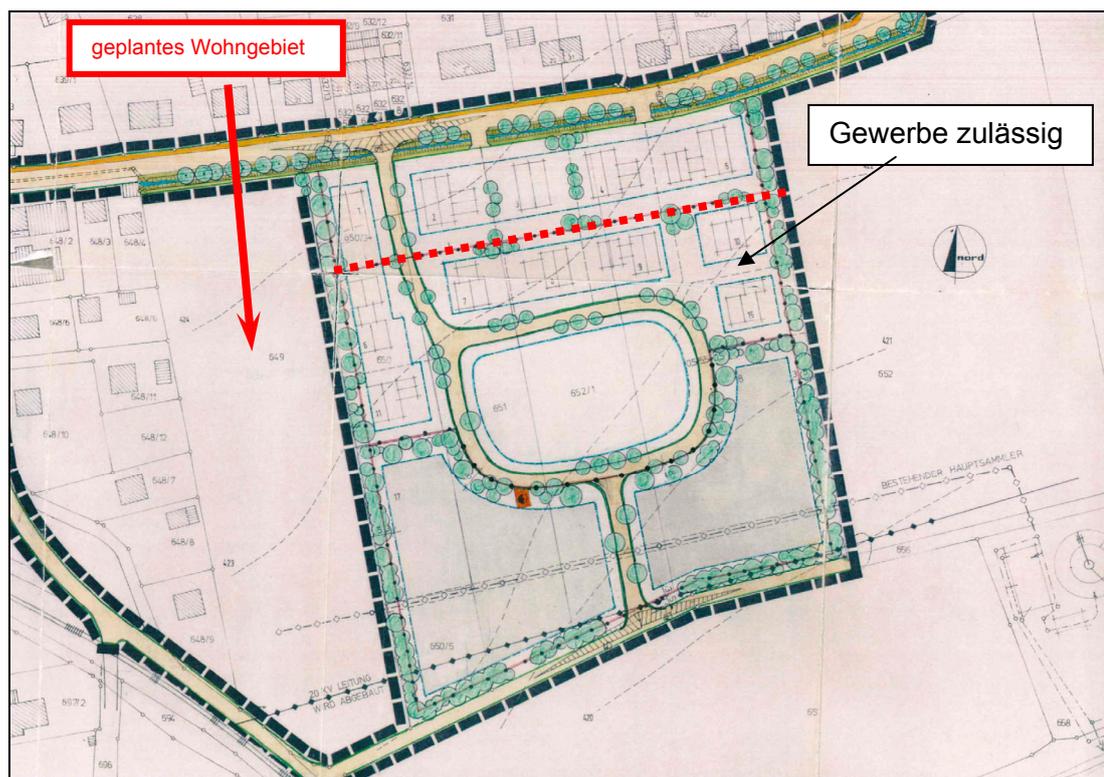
Bebauungsplan "Stockwiese"; Lageplan
